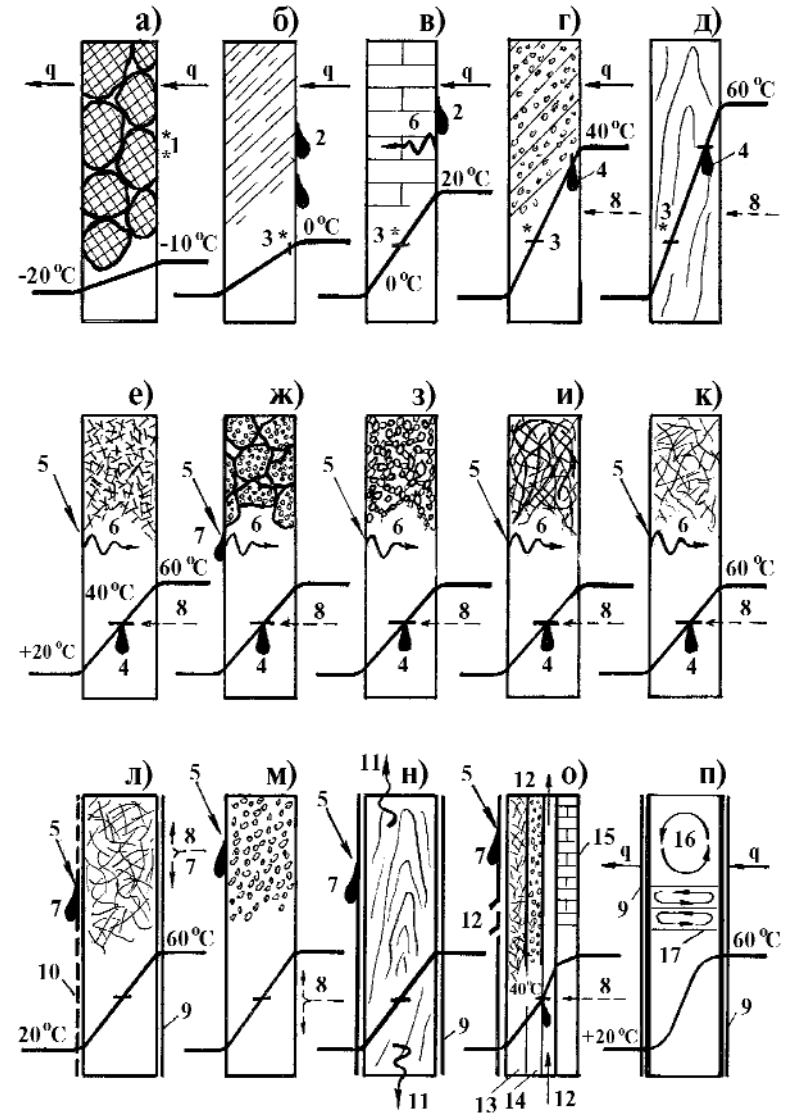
Модельные примеры пароветрогидроизоляции помещения бани из следующих материалов: а – кладка каменная (бутовая), б – бетон, в - кирпич, г – пенобетон, д – древесина, е – древесно-волоконная плита, ж – лист
